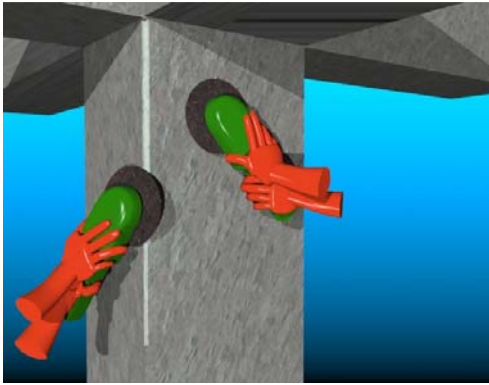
Fixação dos laminados a um elemento de pilar.
